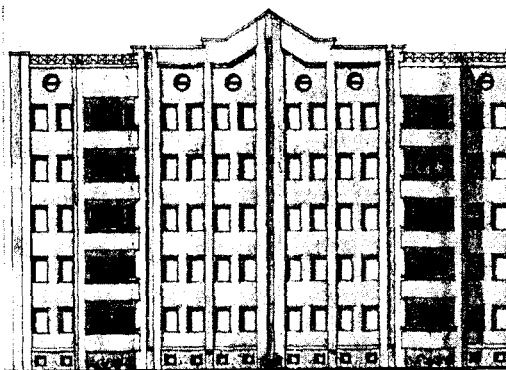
Фрагмент фасада здания архитектурно-строительной системы "ПИК"
